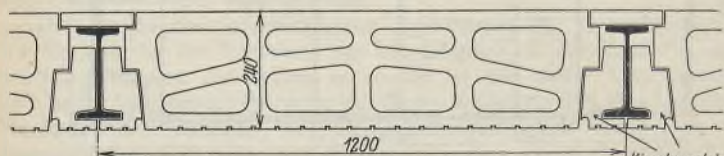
Querschnitt der geplanten Bürohausdecke und ausgeführten Dachkonstruktion.
